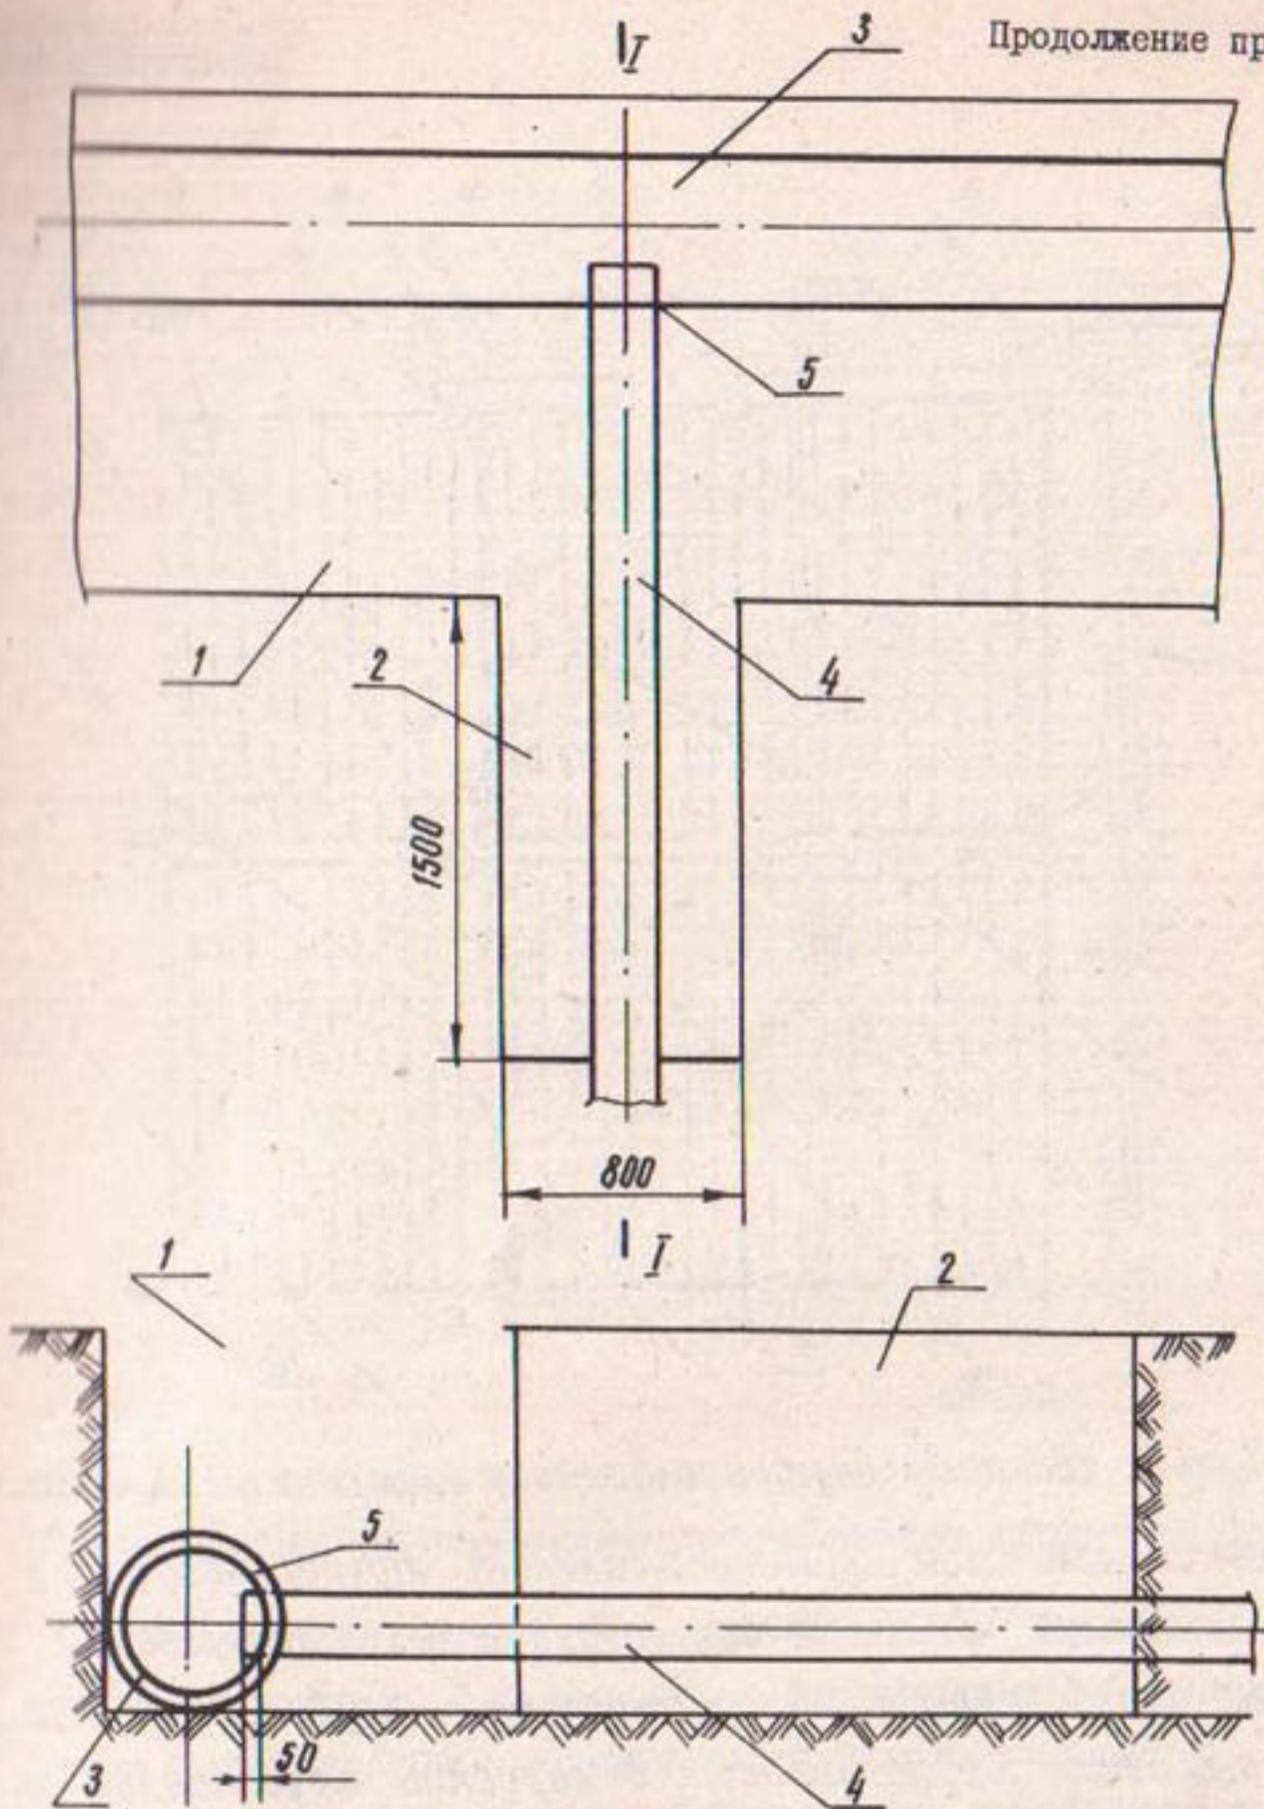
Схема соединения оросительного, сбросного и увлажнительного трубопроводов.
